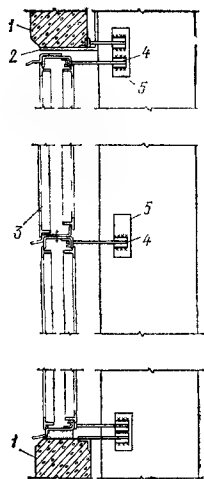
Крепление оконных панелей серии ПР-05-50/73 к железобетонной колонне
